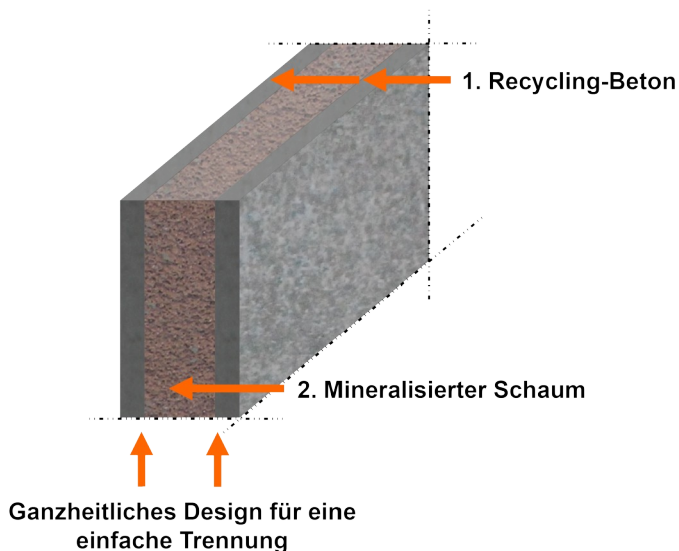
Konzept eines materialkonformen, voll rezyklierbaren Beton-Beton-Sandwich mit signifikant reduziertem Treibhauspotential.
